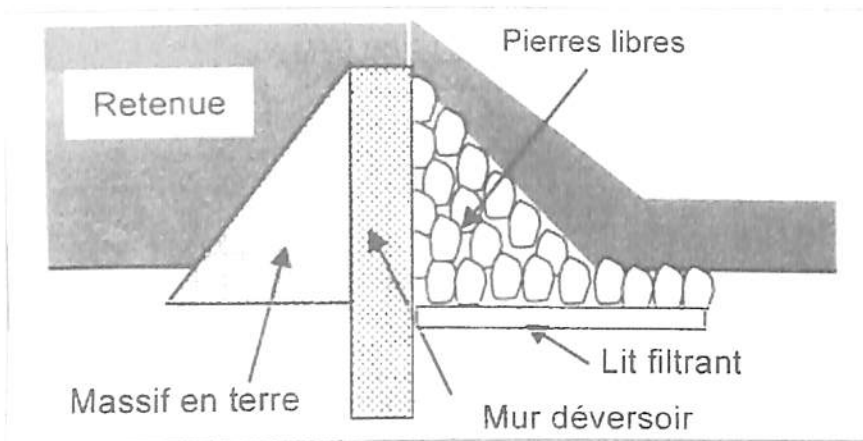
Schéma d'une digue déversante sans tranchée d'étanchéité.
